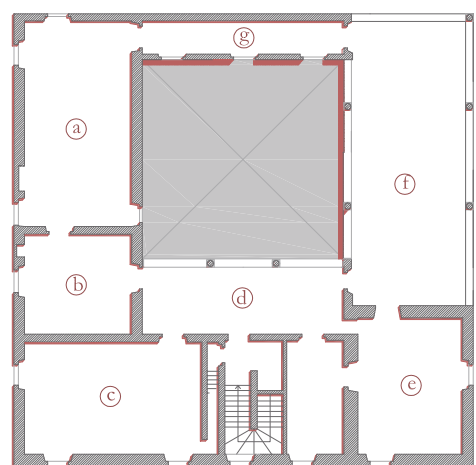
Schema planimetrico ricostruttivo del piano interrato di villa La Luna nello stato originario, 1470-1475 (elaborazione B. Mazzanti).
